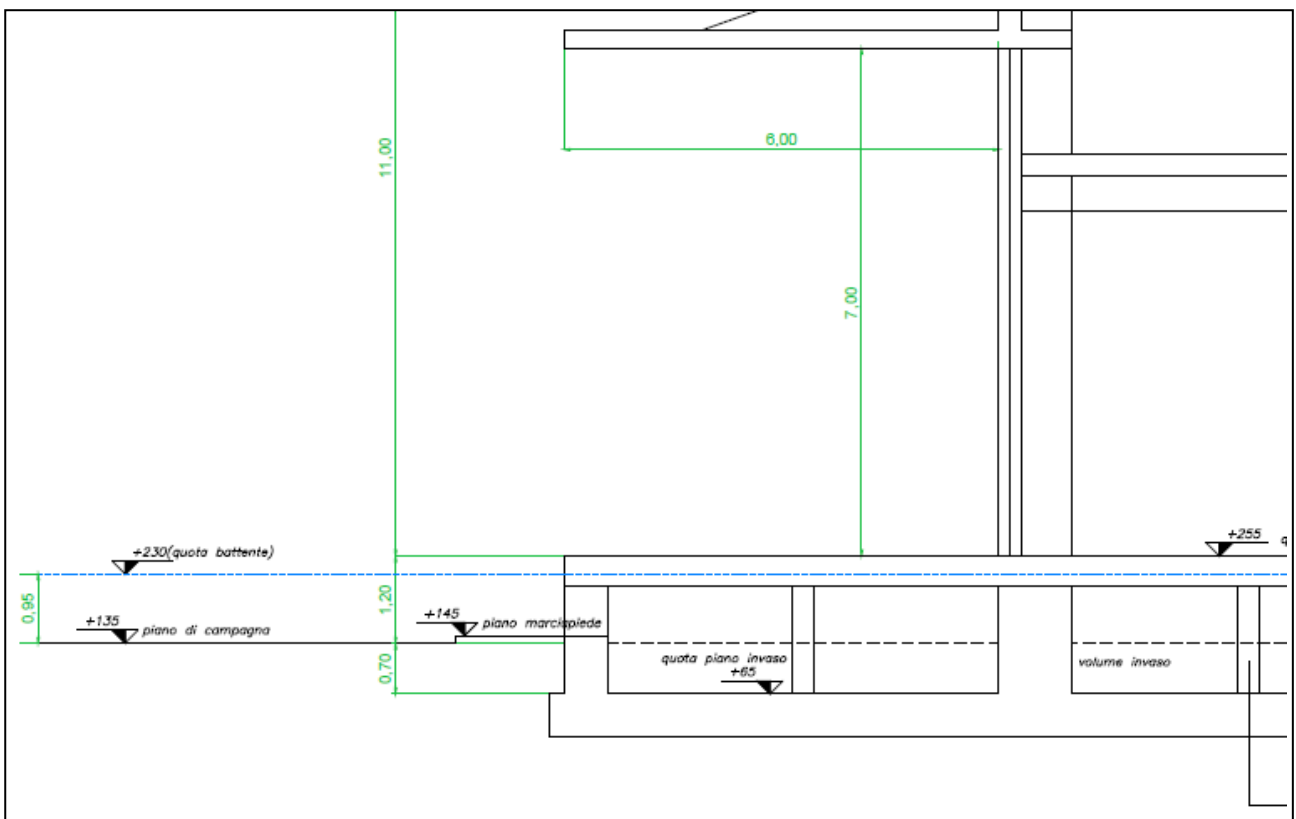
Sezione tipo di capannone (particolare con indicazione delle quote)
